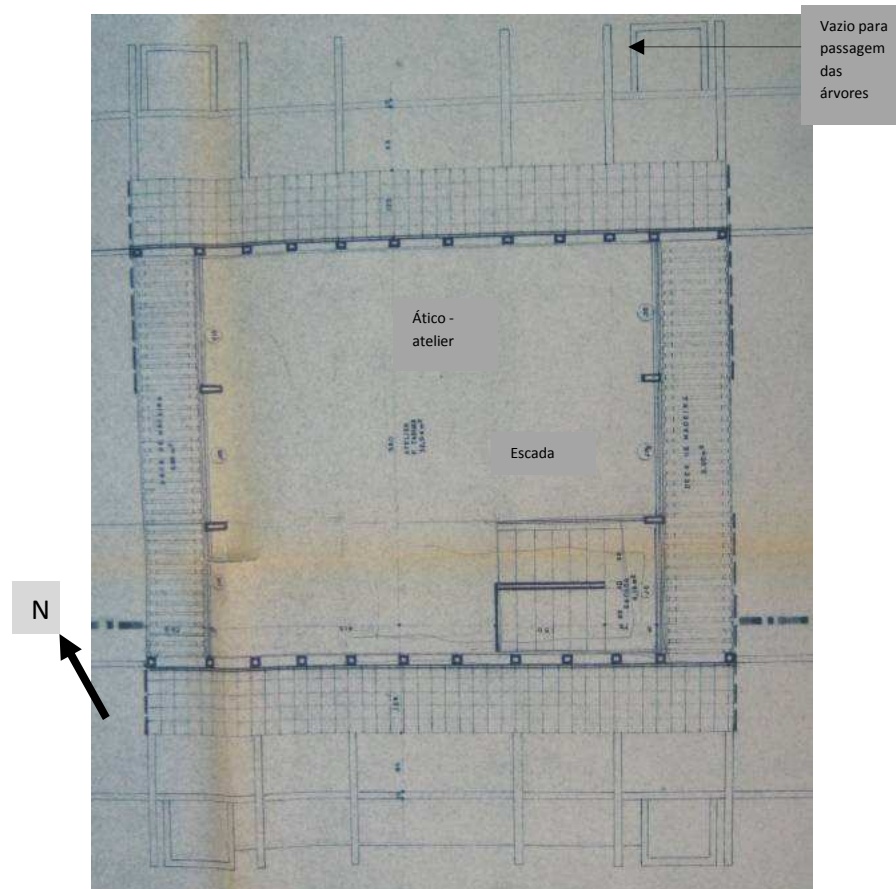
Residência Othello Lopes Filho*: Planta do ático (aproveitamento do sótão).
